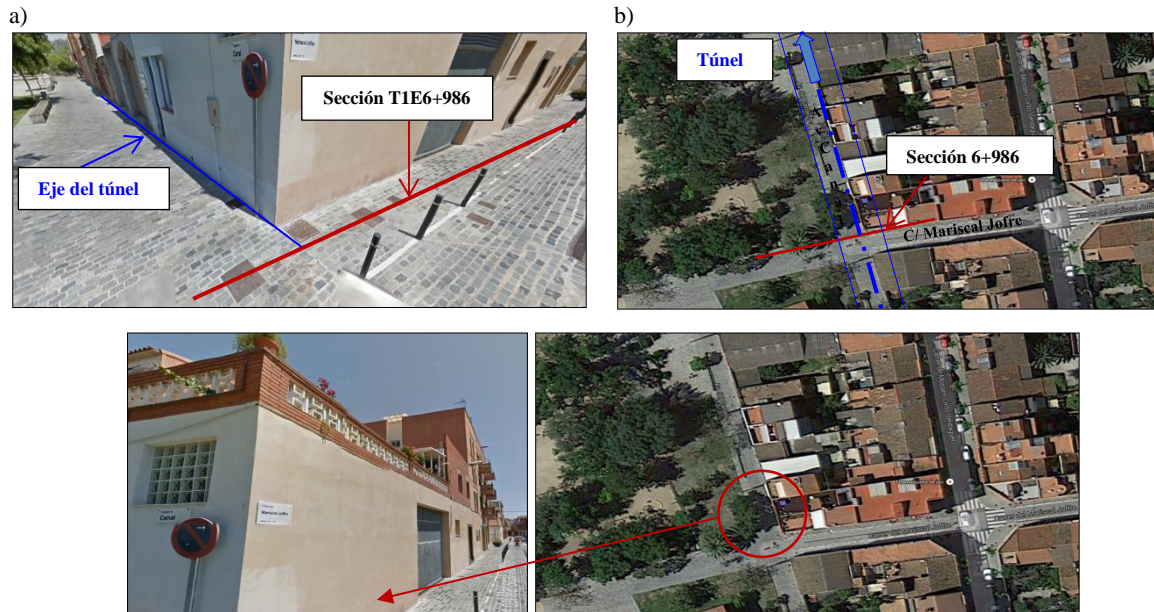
37. a) Vista desde satélite en alzado b) Vista desde satélite en planta, sección T1E PK 6+986. Fuente: Google Maps c) Vista de los edificios situado en el extremo derecho de la excavación
